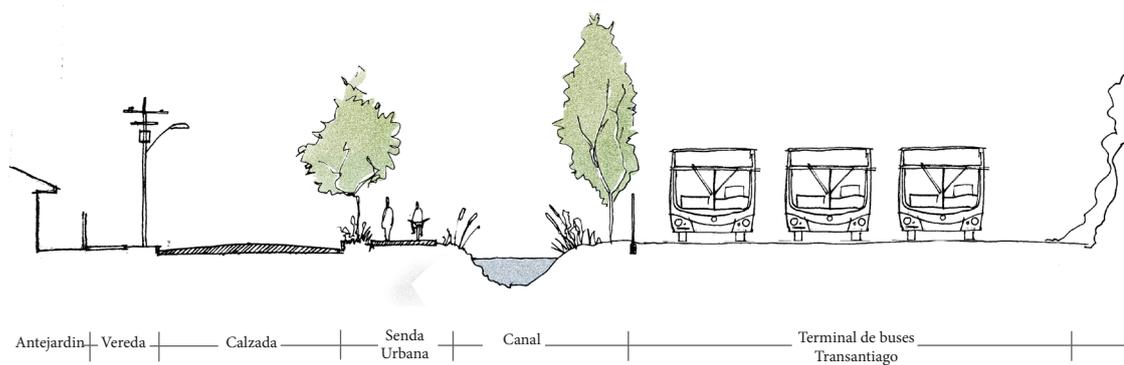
Corte esquemático perfil tipo Cerro Hasbún
